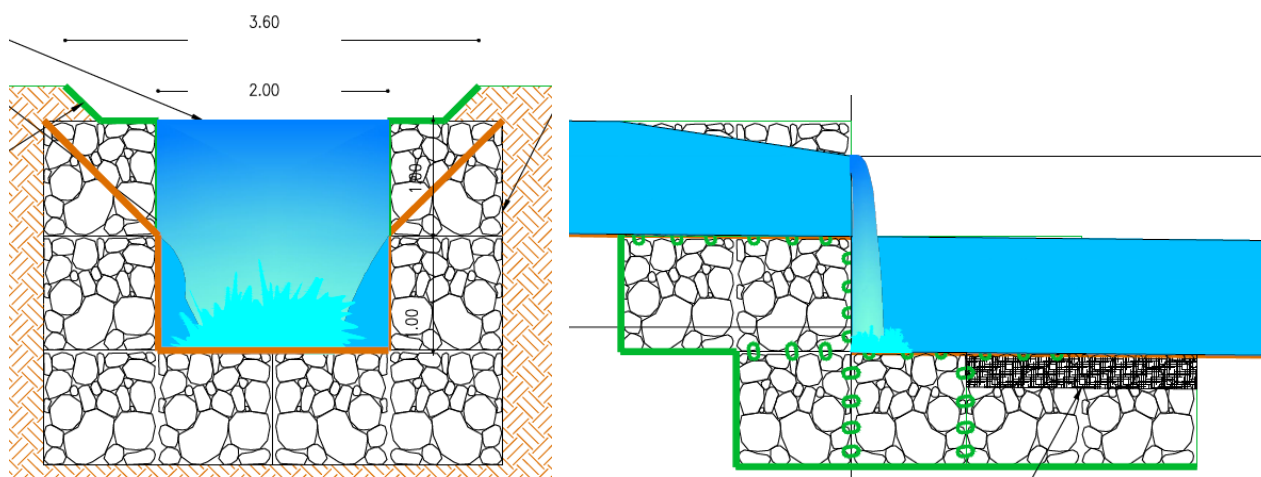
Vista prospettica e sezione longitudinale della sezione di salto
